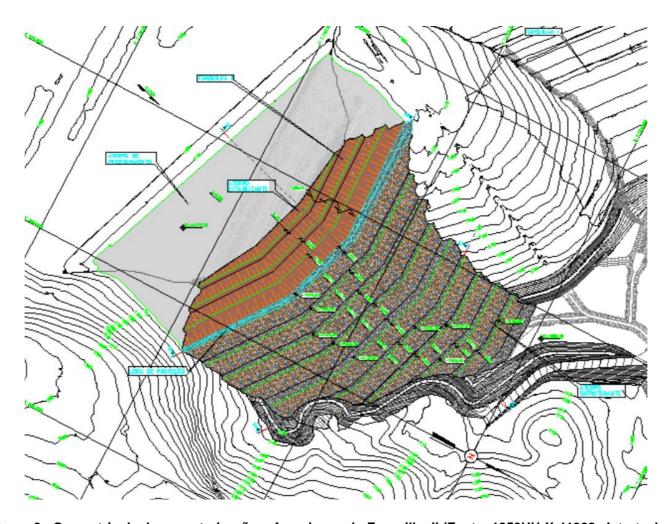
Geometria de descaracterização – Arranjo geral - Forquilha II (Fonte: 1850HH-X-41368– Intertechne)
